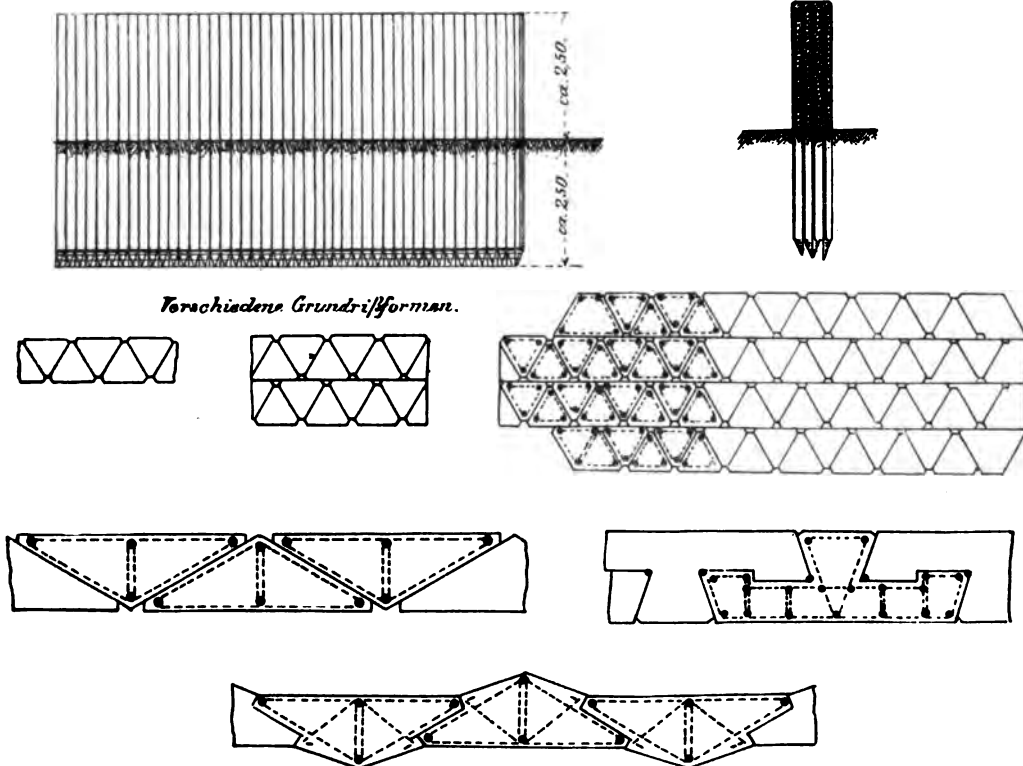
Strandbuhnen aus Eisenbetonpfählen nach Möbus.
